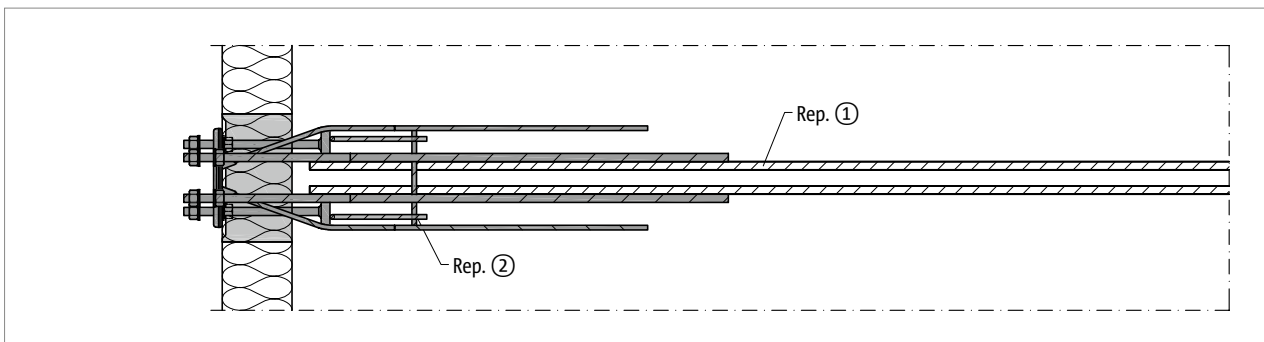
Schöck Isokorb® XT type SK-M1 : armatures à prévoir par le client, vue en plan
